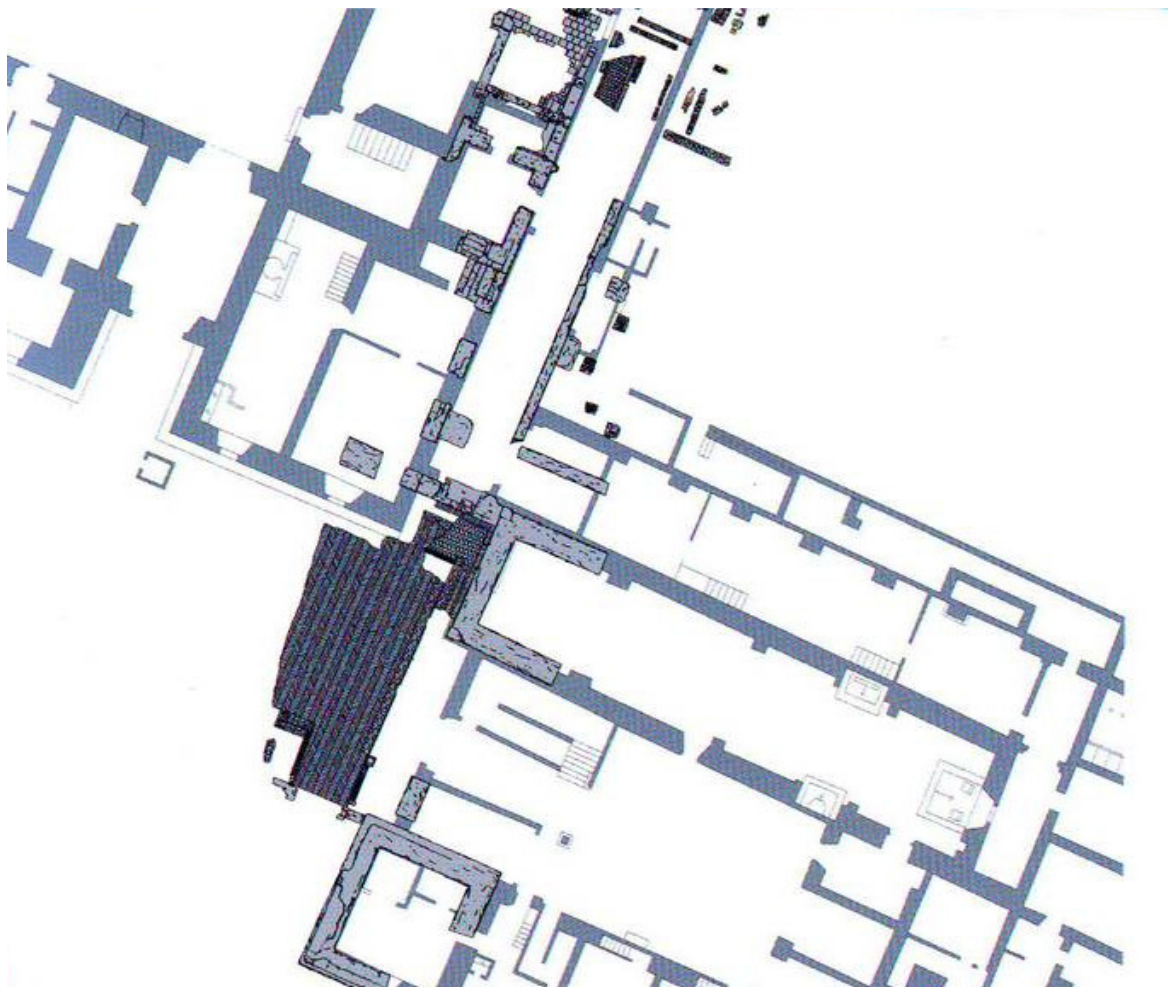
, Detalle del plano de planta sobre el que sitúa en negro los restos hallados en las excavaciones de la década de los 80.
